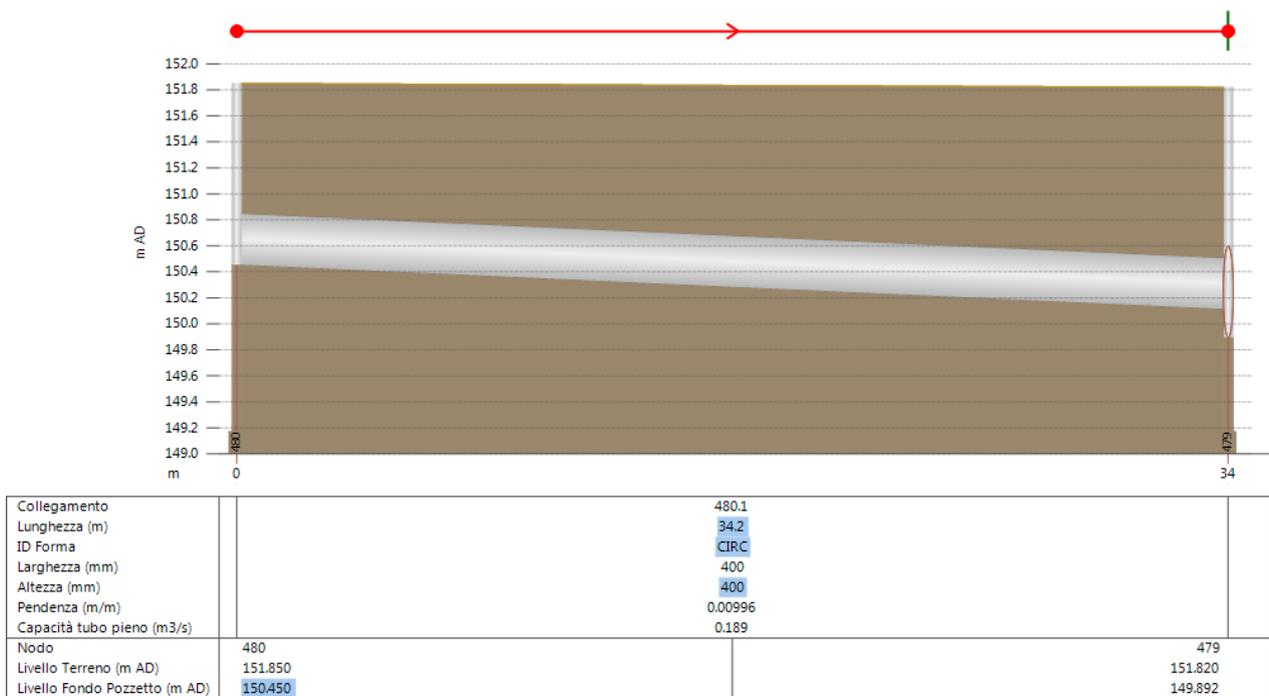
Profilo di progetto, raccordo laterale tratto da camera 480 a camera 479
